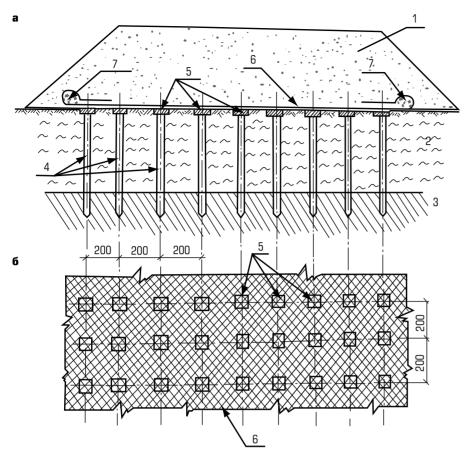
Схема «безосадочной» насыпи на слабом основании: а) поперечный разрез; б) план армогрунтового ростверка: 1 — тело насыпи; 2 — слабые грунты основания; 3 — более прочные грунты основания; 4 — забивные железобетонные сваи сечением 35 imes 35 см: 5 — железобетонные сборные оголовники свай; 6 — армогрунтовый ростверк в виде мембраны из высокопрочной геосинтетической ткани Stabilenka; 7 — анкерные элементы
